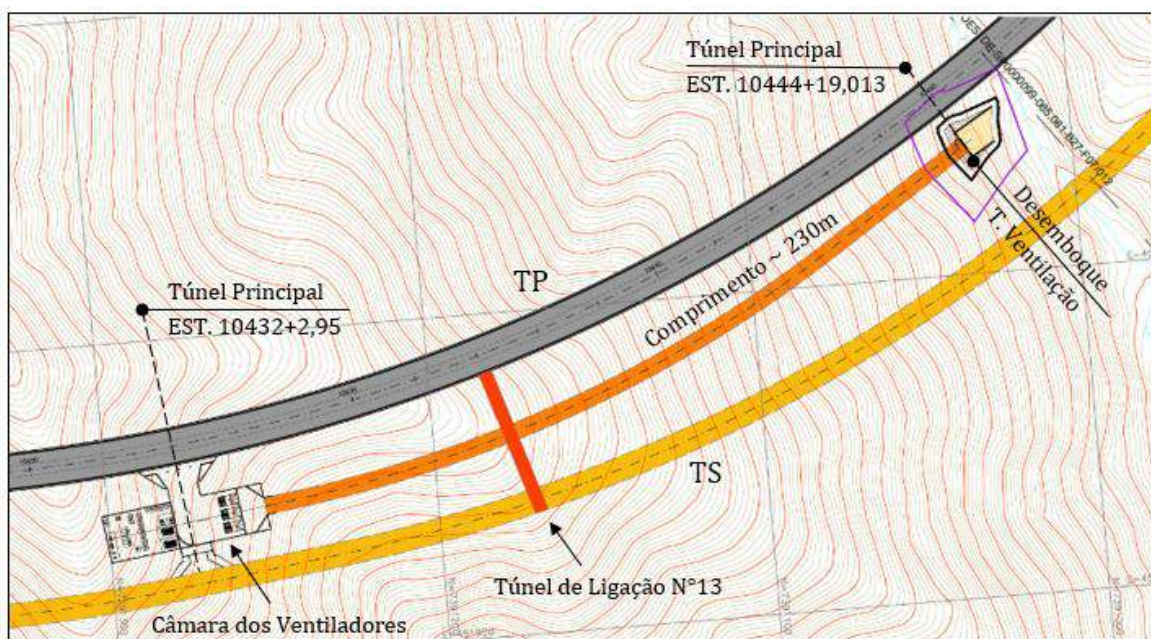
Planta com a Posição Câmara dos Ventiladores e túnel de Ventilação
